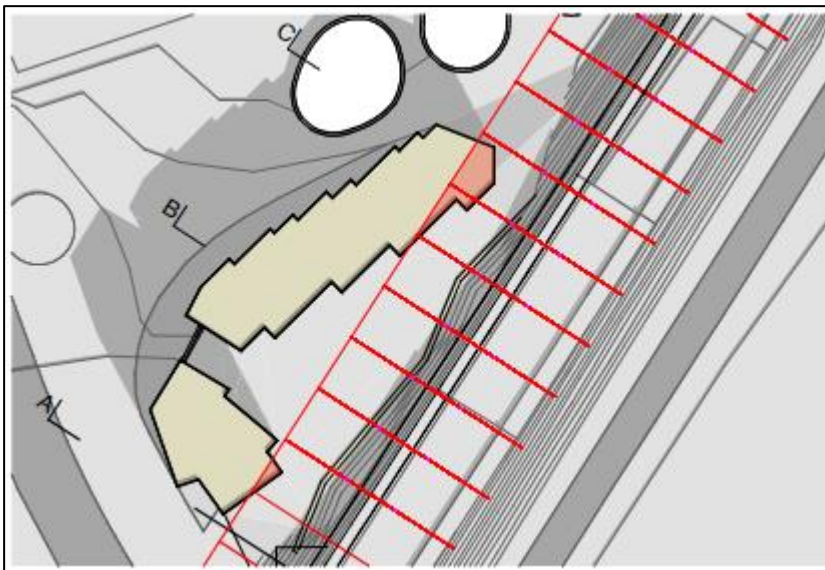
Incidence selon Orni, plan d'implantation. AC Architectes, 20.09.2023
